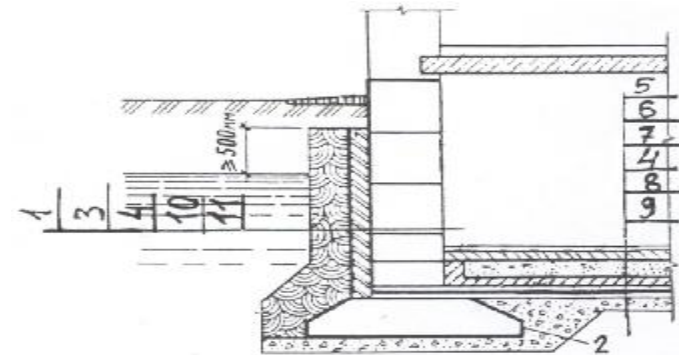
Изоляция фундаментов от агрессивных подземных вод:
